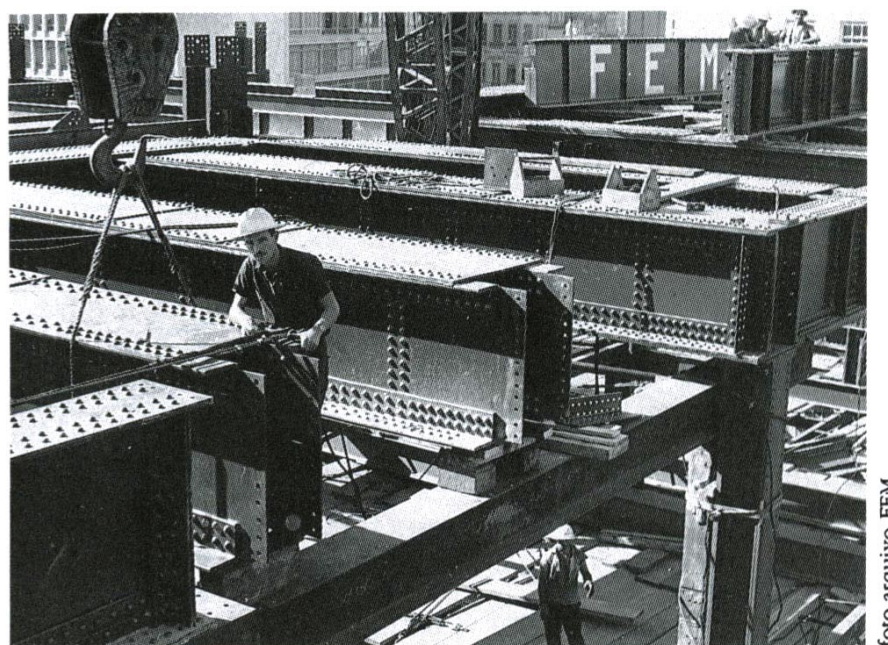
Edifício Avenida Central: içamento e posicionamento das vigas de seção caixão no quarto pavimento
